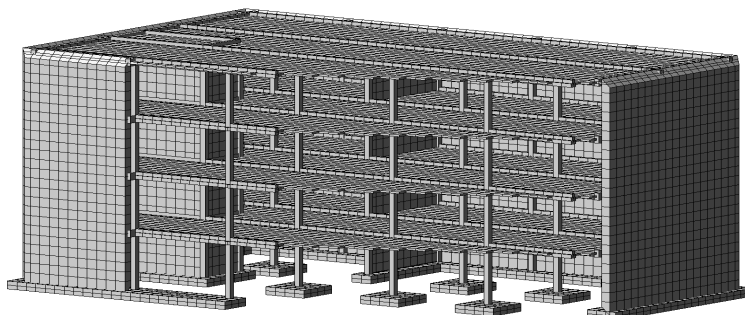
Конечно-элементная расчетная схема здания с ленточным фундаментом
